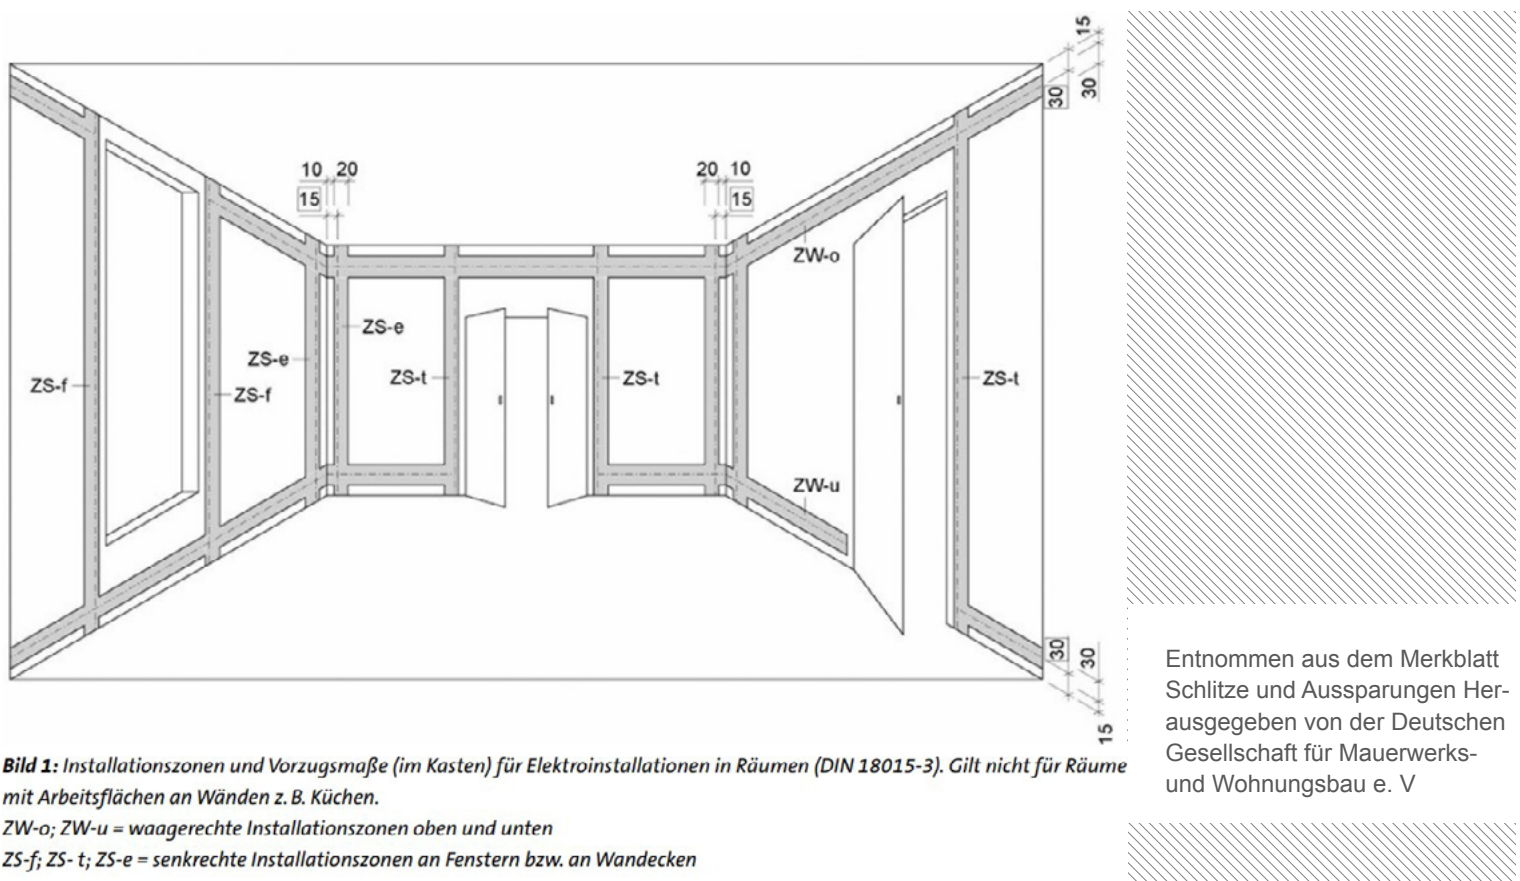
Installationszonen und Vorzugsmaße (im Kasten) für Elektroinstallationen in Räumen (DIN 18015-3). Gilt nicht für Räume mit Arbeitsflächen an Wänden z. B. Küchen.
